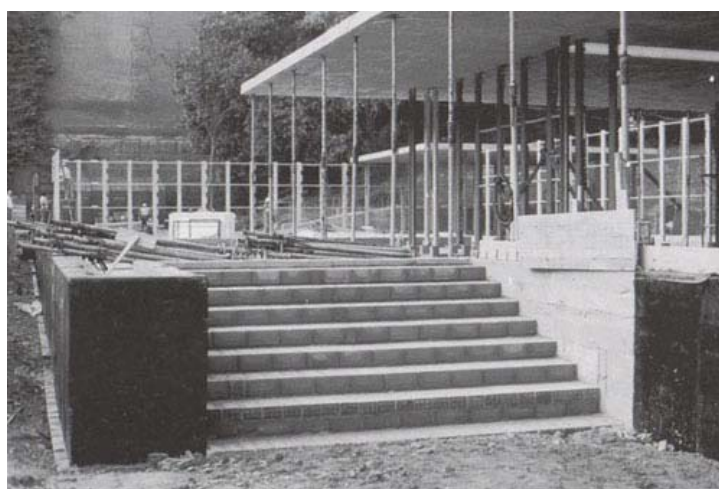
Pavilhão Barcelona. Plataforma e estruturas metálicas antes de receber o revestimento de pedra.
